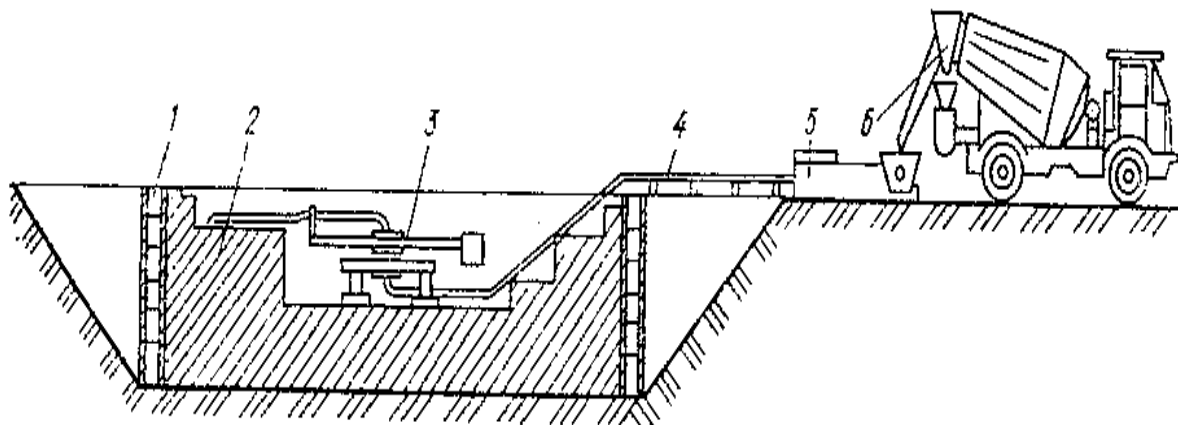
Бетонування фундаментів бетононасосом і механічним маніпулятором?
